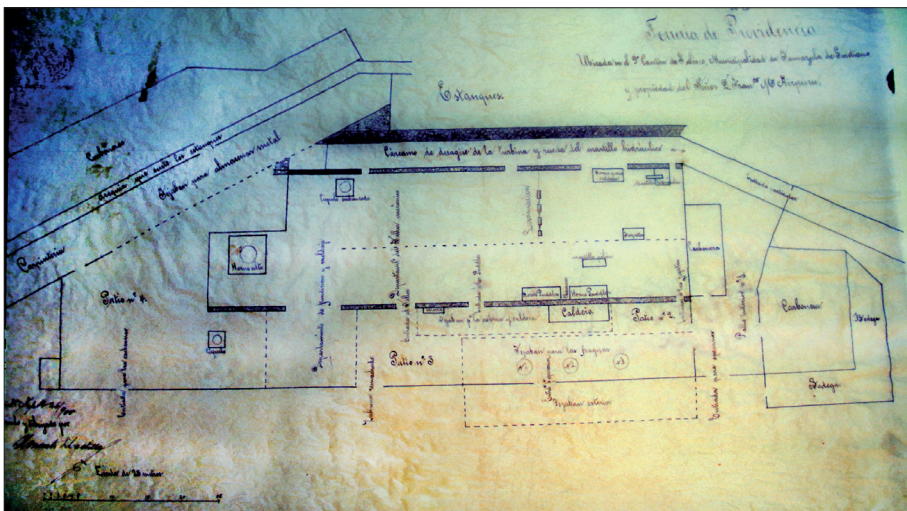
Plano de la Ferrería La Providencia, 1900. Fuente: Flores, 1980:27.
